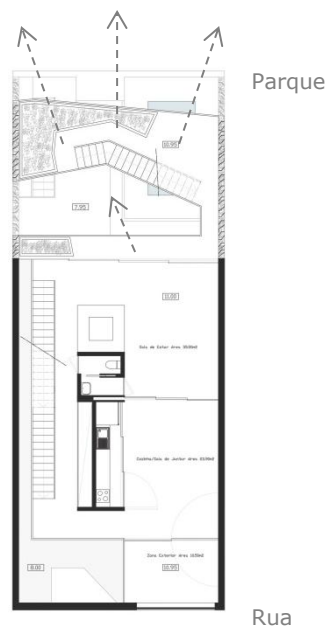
Planta do Piso 1 e Sistema de Vistas
